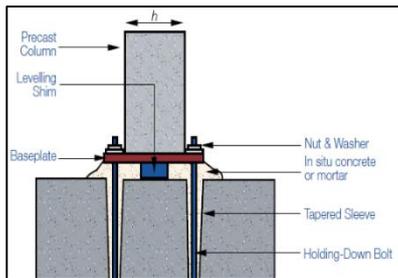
pied du poteau (Source: Precast_Concrete_Frames_Guide.pdf)
